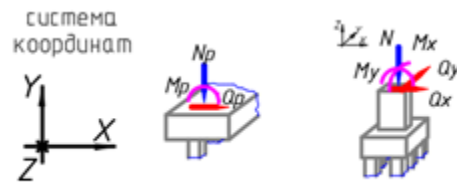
Схема прикладання навантажень на плитний фундамент
